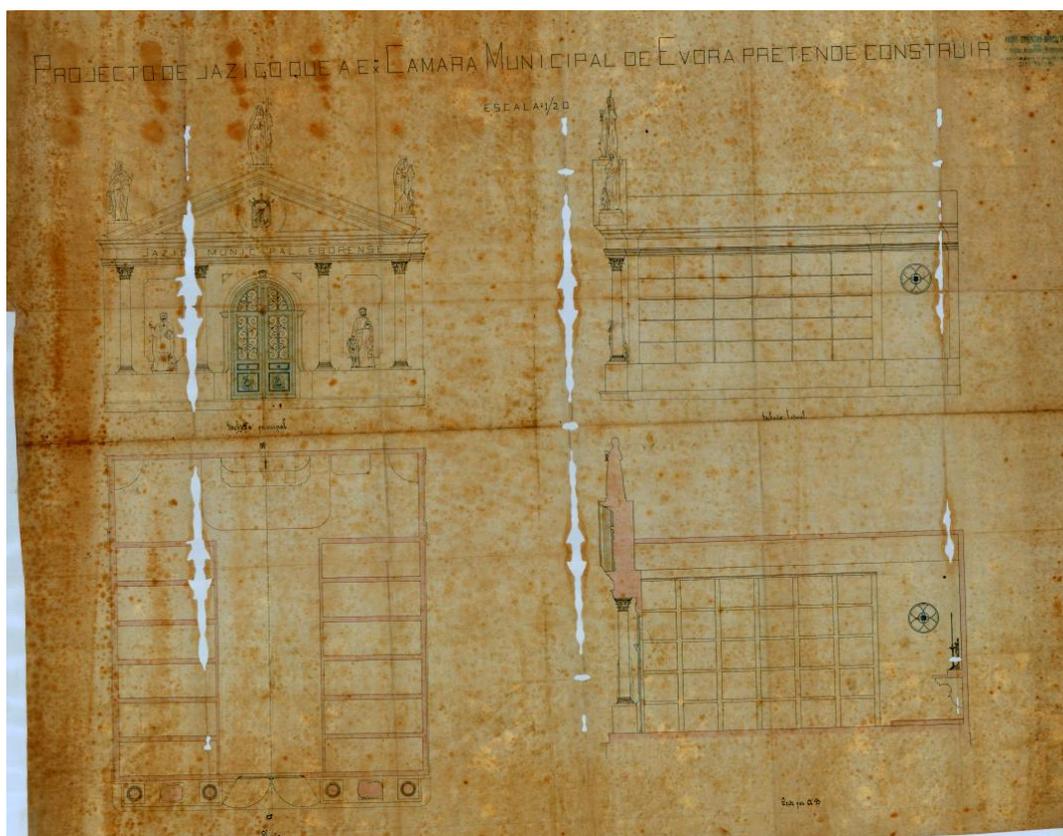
Planta de Jazigo Municipal. Fonte: Arquivo C.M.E.
